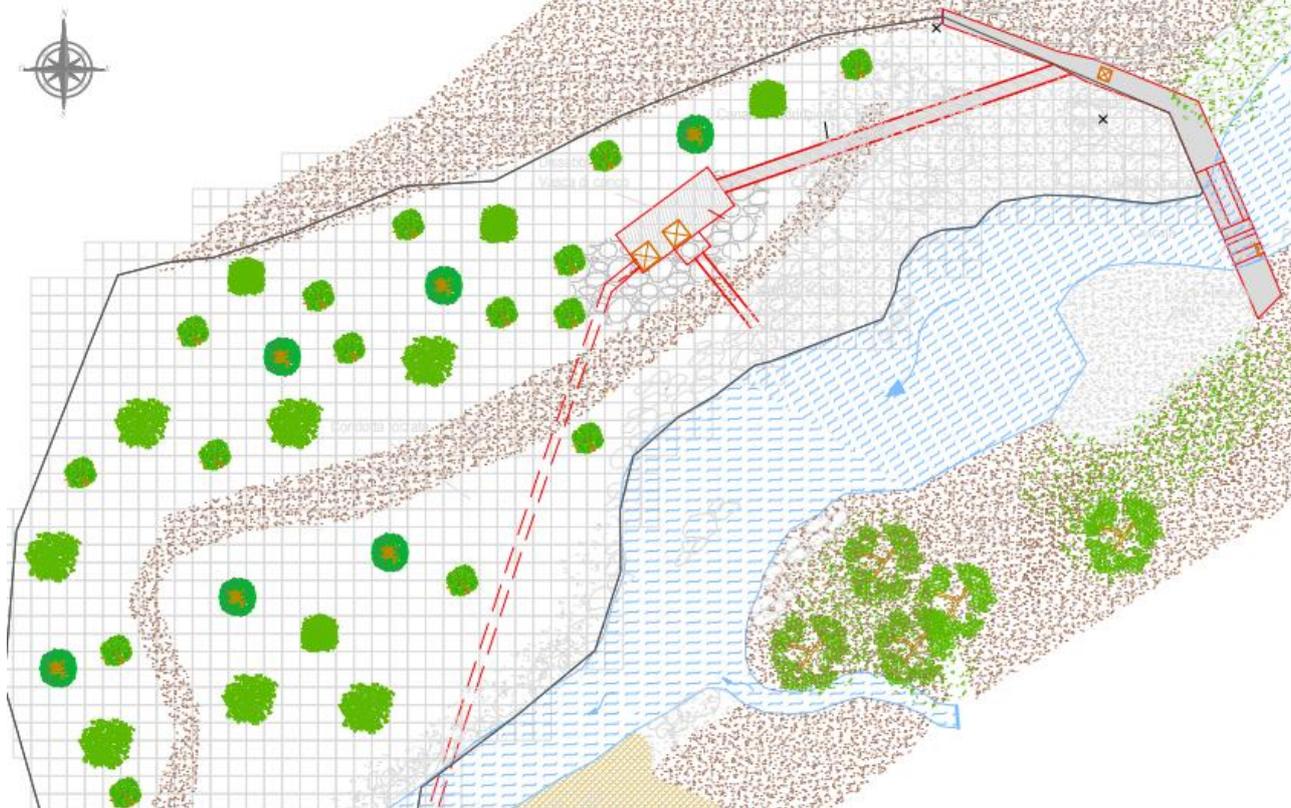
stralcio della planimetria di intervento delle piantumazioni previste nelle superfici interferite durante la realizzazione delle opere di derivazione.
